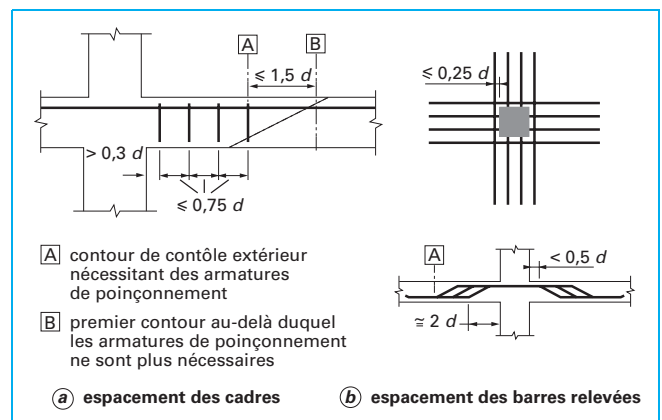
Armatures de poinçonnement (figure 9.10 de l'EC2)
